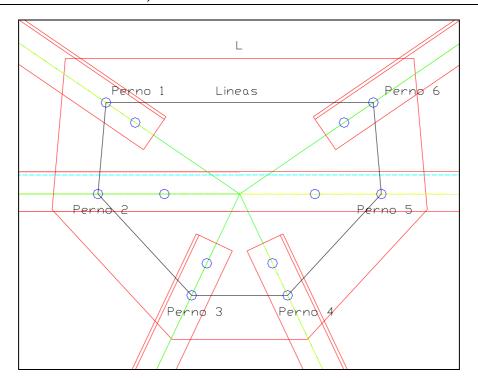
Líneas Trazadas para la Construcción de la Plancha
